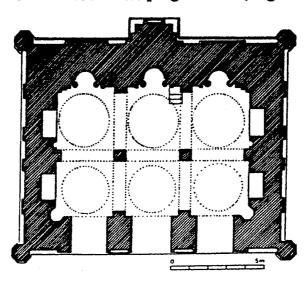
مسقط أفقي للجامع العتيق أو القديم في ادرنه .
